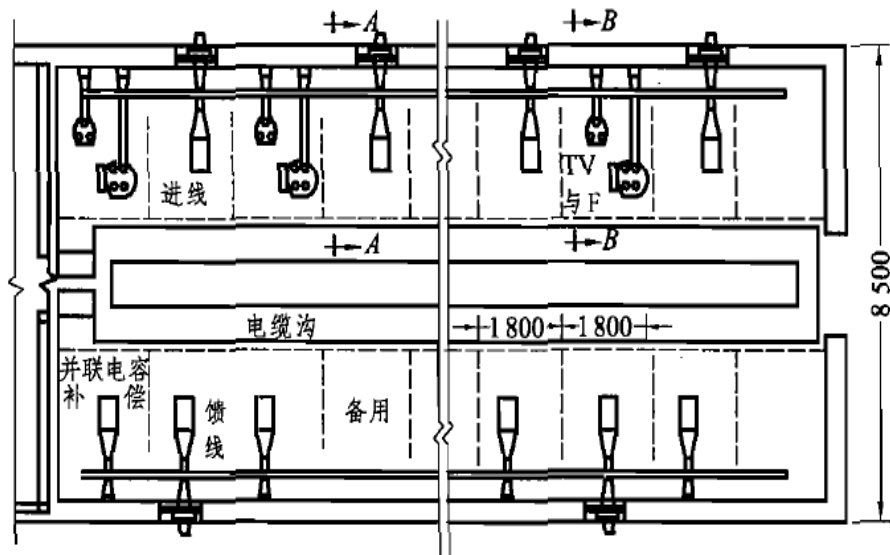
25 kV 屋内配电装置平面布置图 (单位: mm)
